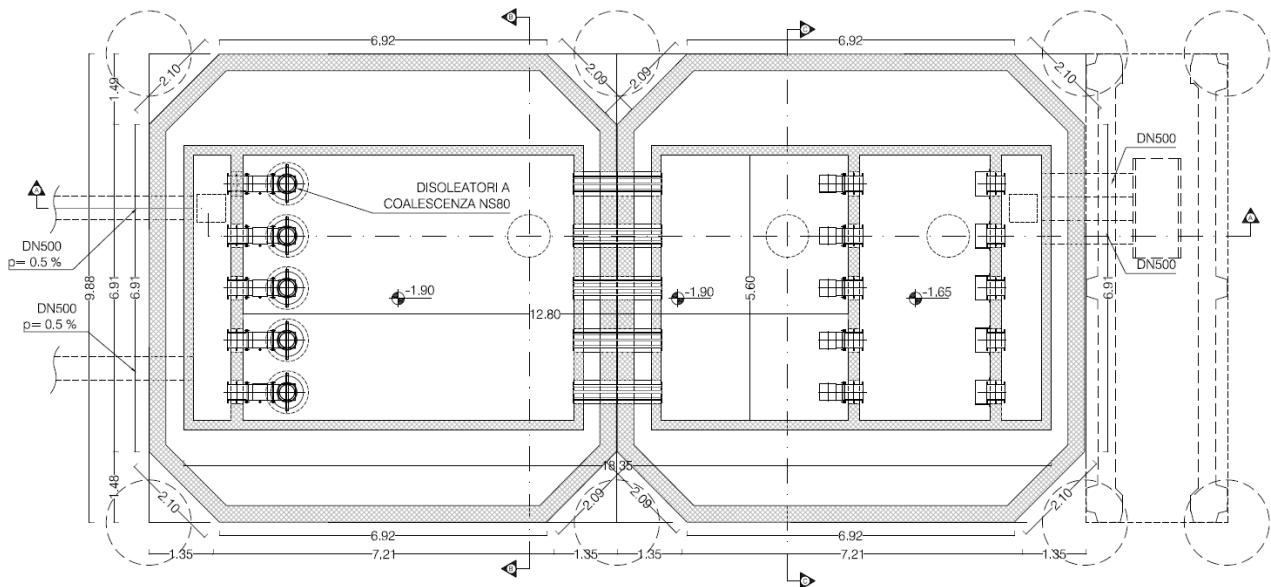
Pianta dell'impianto di trattamento installato in piastre speciali
